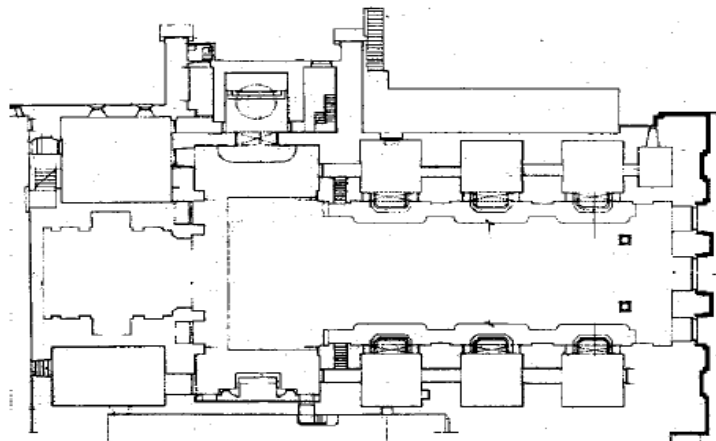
Planta da igreja do convento dos Grilos (Porto) [3]
